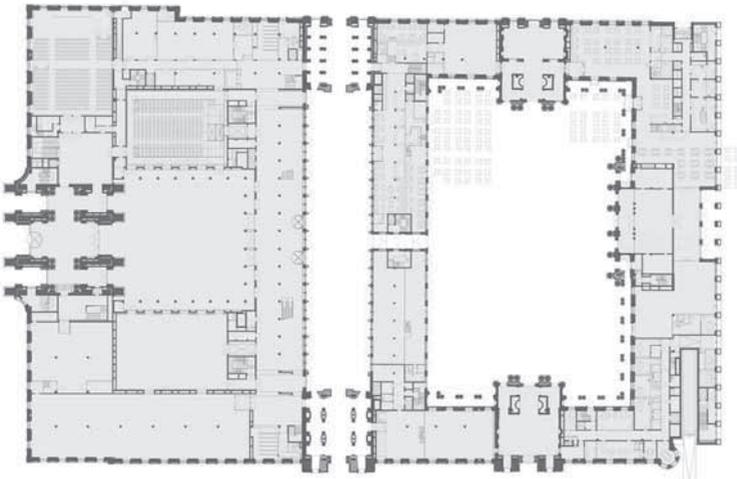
Grundriß Erdgeschoss, Architekt: Franco Stella, Quelle: Stiftung Berliner Schloss – Humboldt-Forum.
